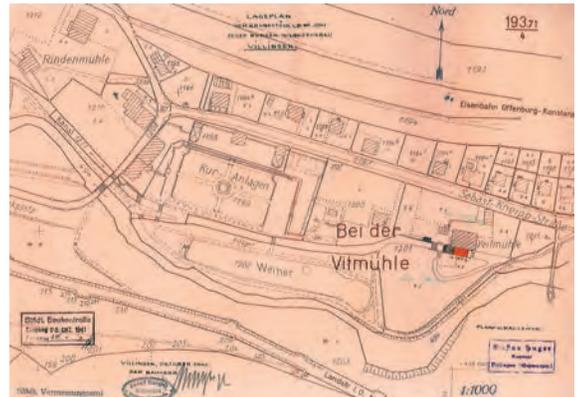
Lageplan der Vitmühle mit Kurpark 1941.
